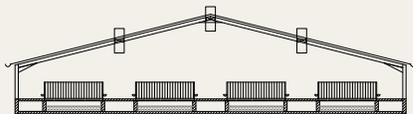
VUE EN COUPE D'UN BÂTIMENT TYPE TUNNELS DE VEAUX DE BOUCHERIE
